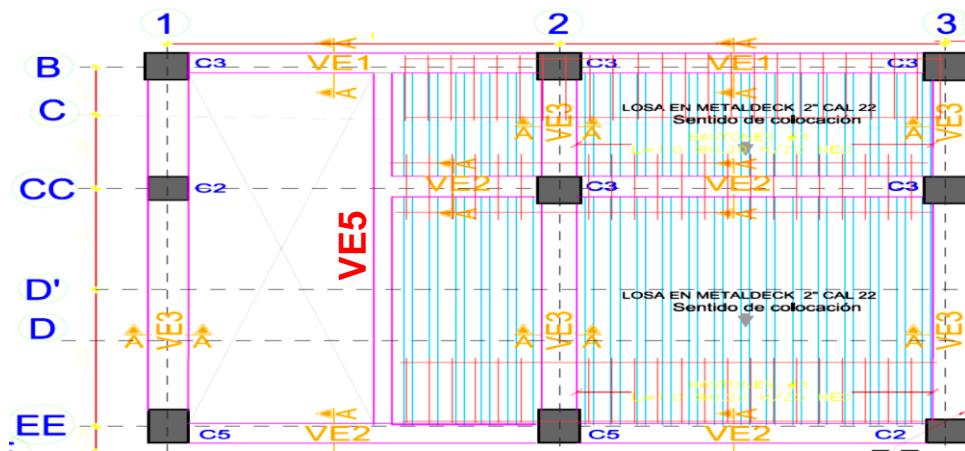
PLANTA DE ENTREPISO EN EL NIVEL 2 DEL BLOQUE 2 (+3,00 MTS)
